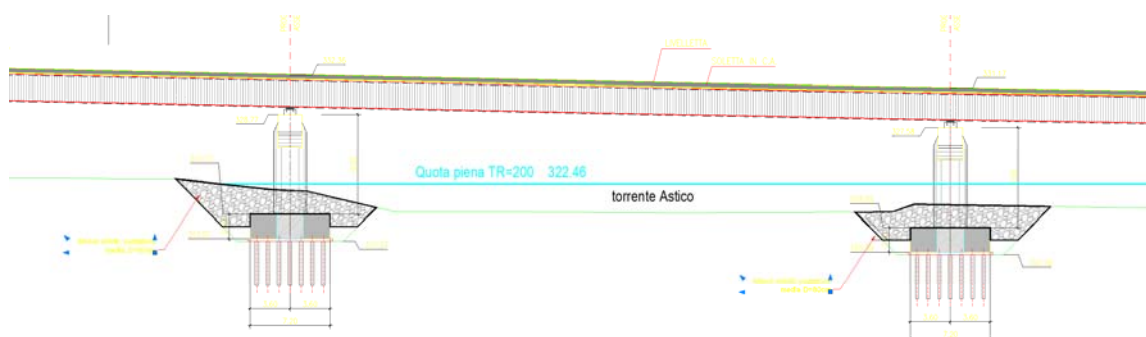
Viadotto Settecà protezione pile 7 e 6, viadotto Sud
